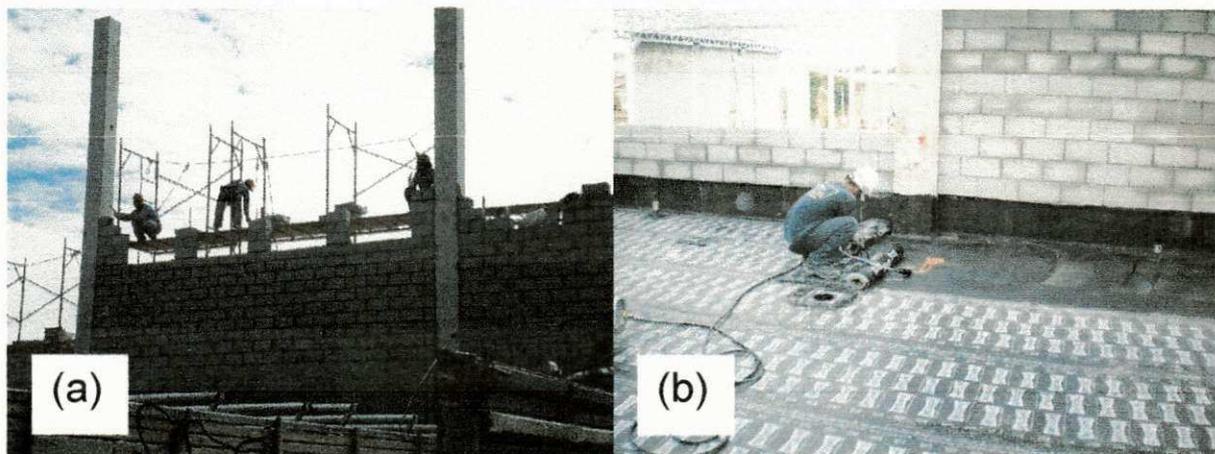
(a) e (b) – Execução da alvenaria e impermeabilização com manta asfáltica
